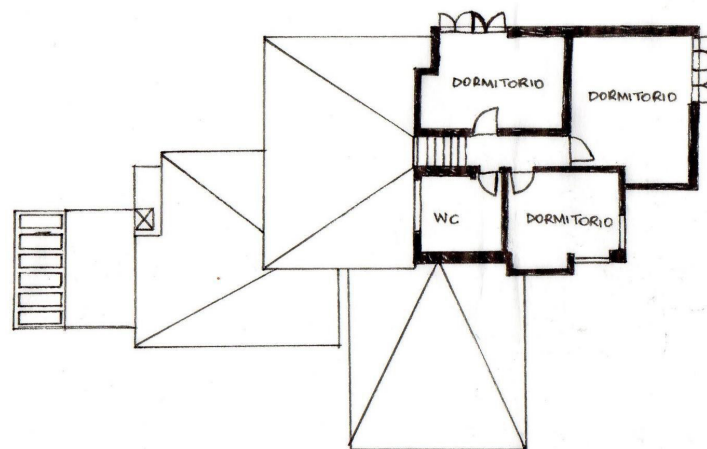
Planta do primeiro pavimento, com os grandes beirais que remetem à obra de Frank Lloyd Wright.
